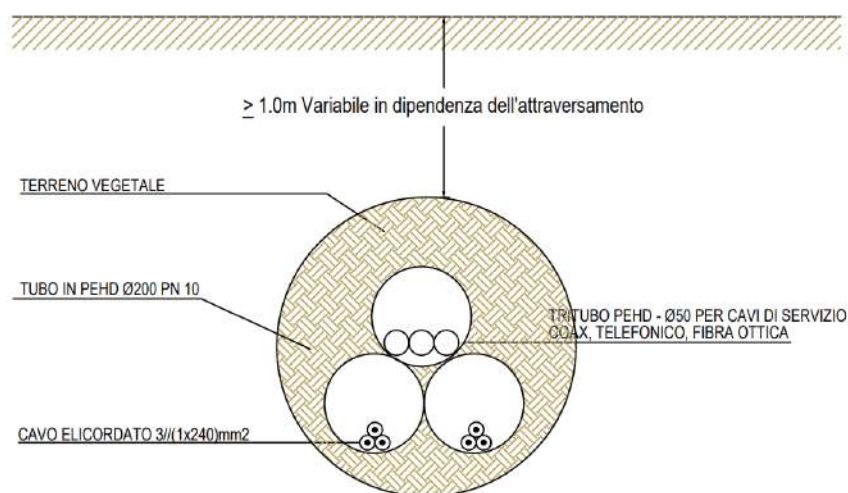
Sezione tipo T.O.C. – Attraversamento con sonda teleguidata
